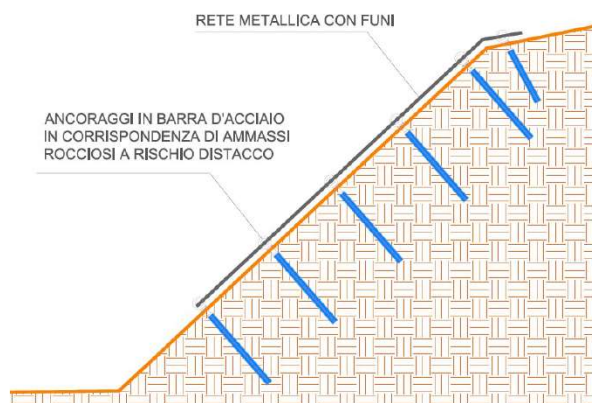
Rivestimento di scarpata con geocomposito, rafforzamento corticale e soil nailing
